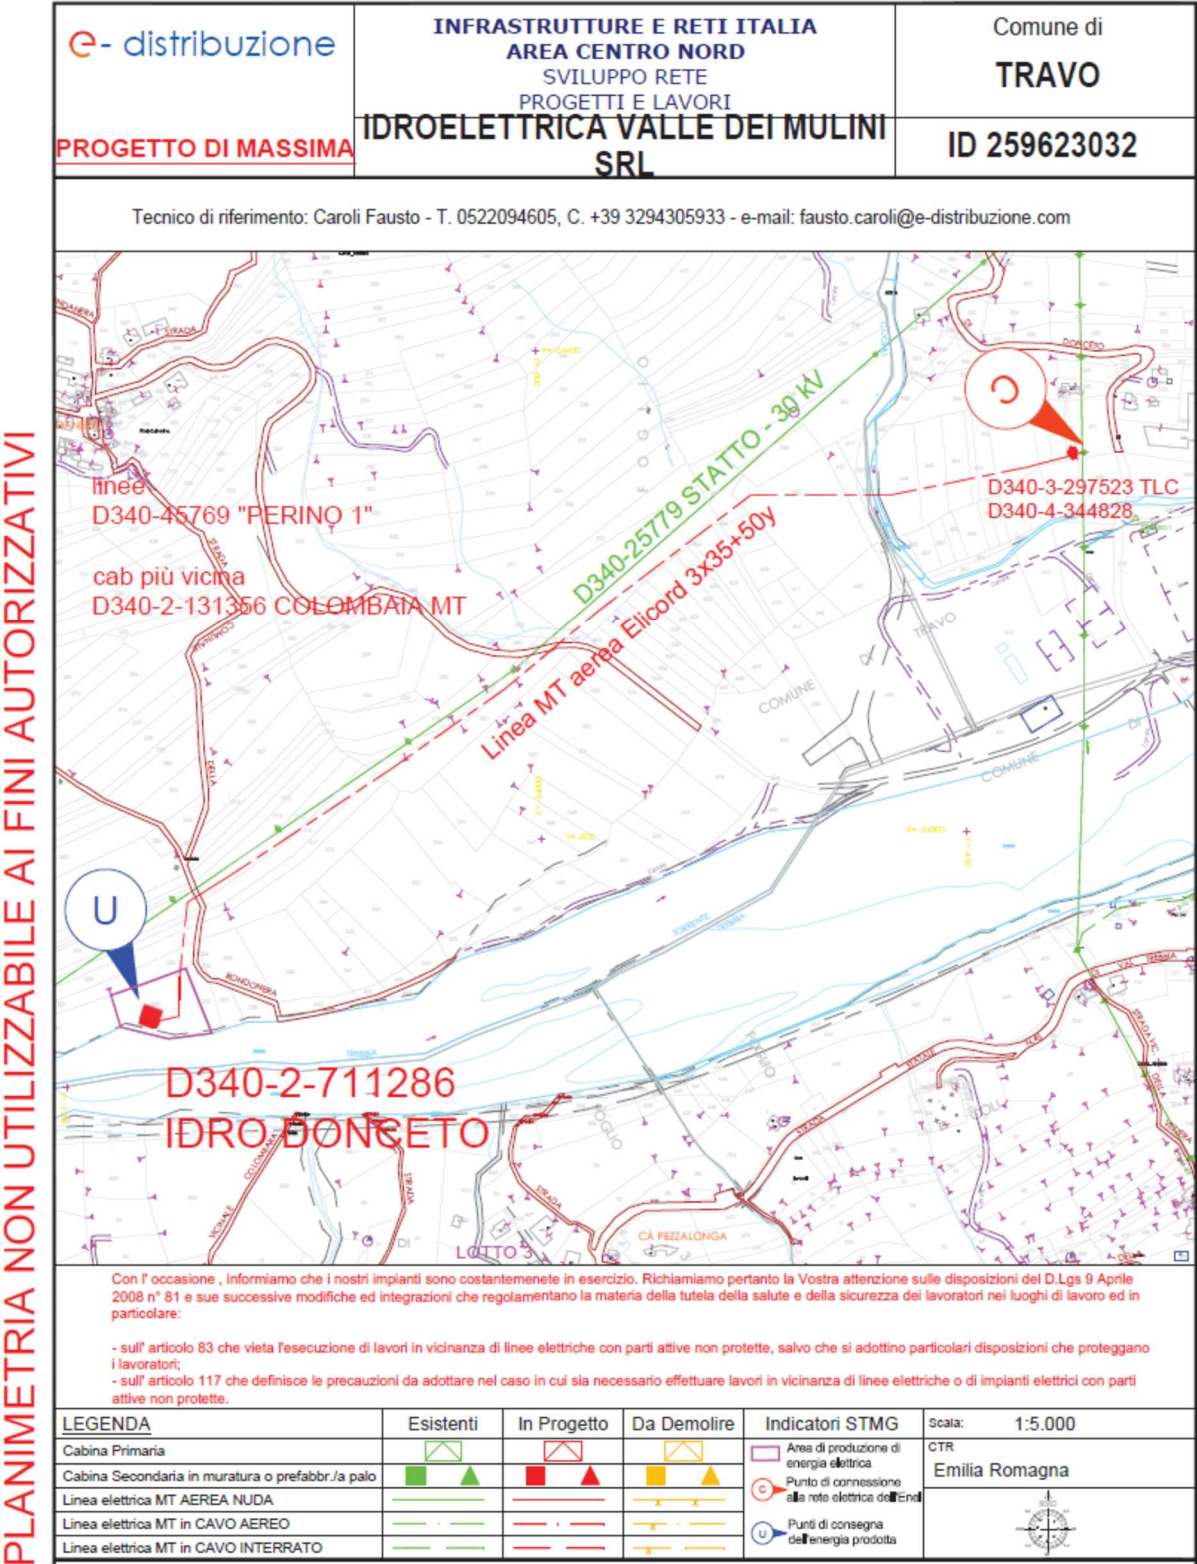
Estratto planimetrico progetto di massima preventivo di connessione.
